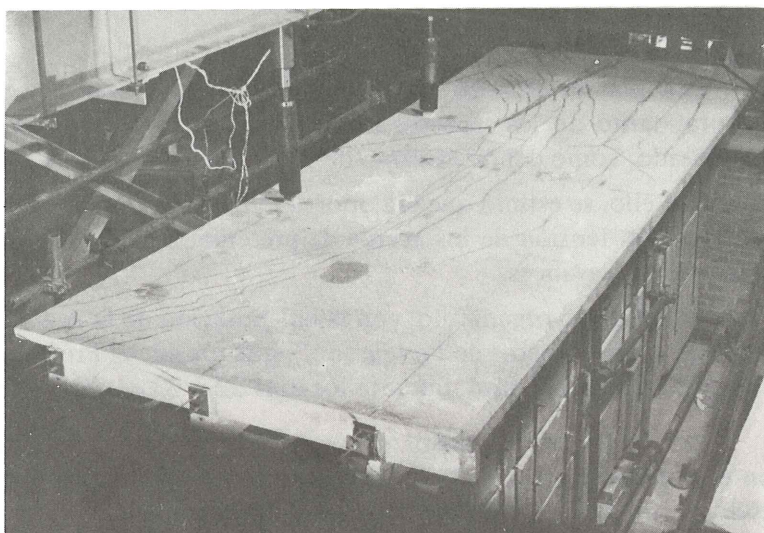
Fisuración del tablero en las proximidades de la rotura.
